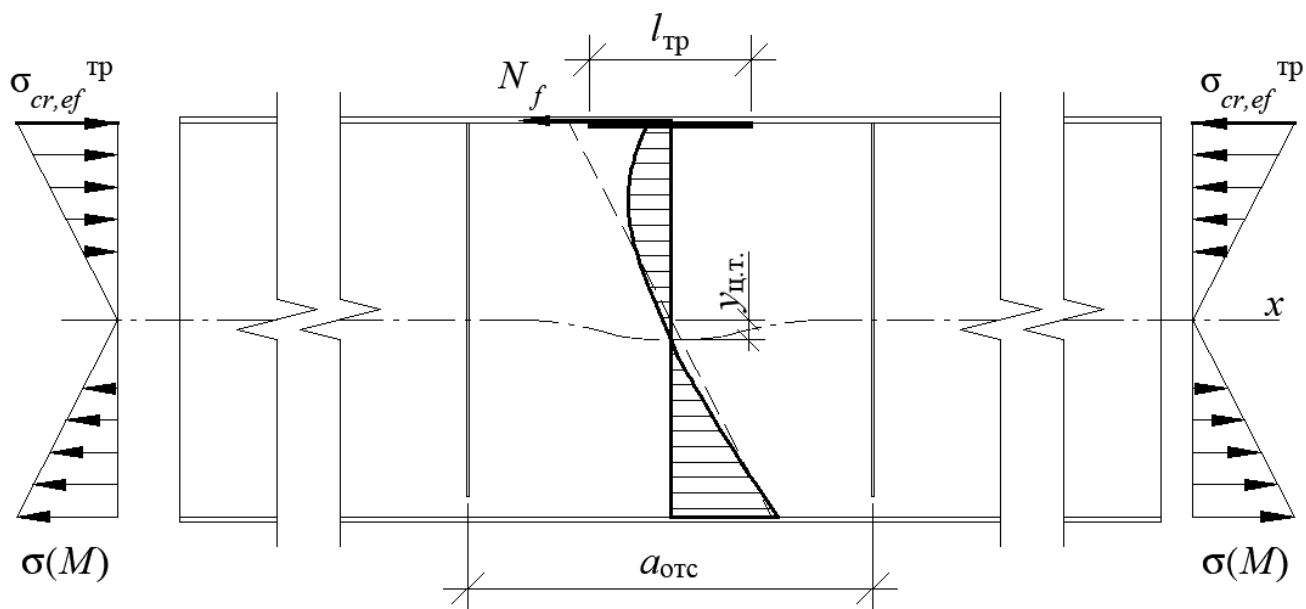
Схема загрузки балки при определении критических нормальных напряжений в стенке с учетом перераспределения усилий.
